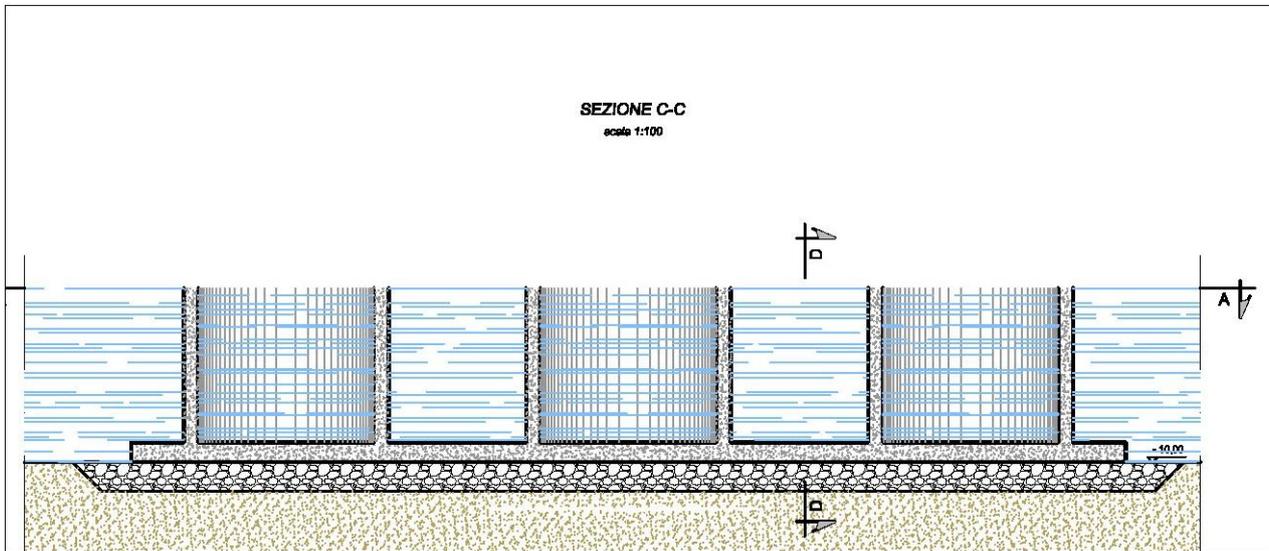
Sezioni longitudinali opere di fondazione previste
